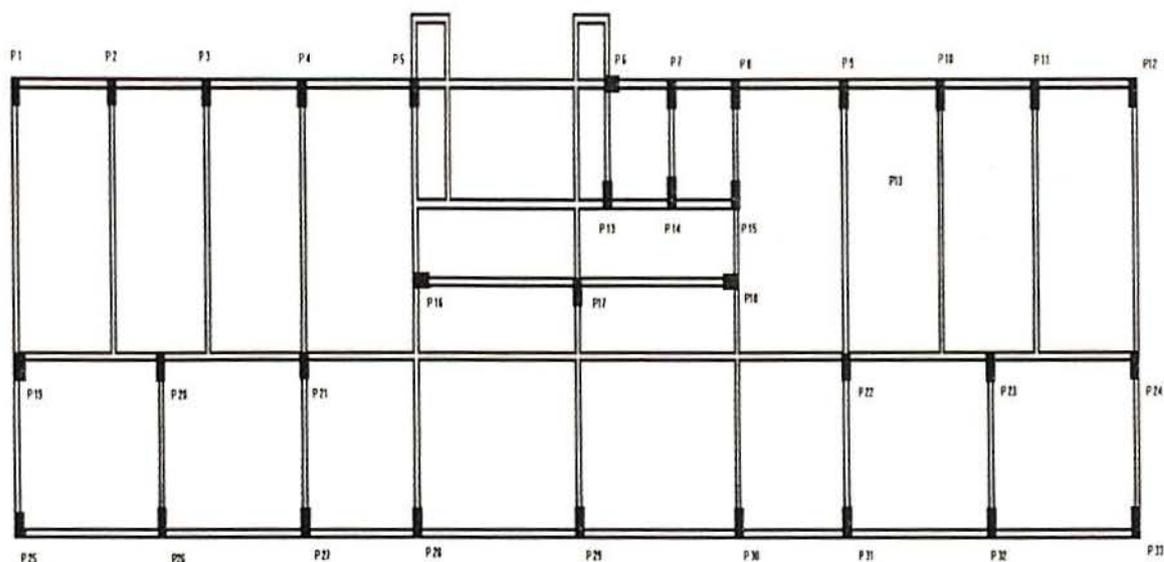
Planta esquemática, nível cintamento, de um edifício residencial com 12 pavimentos
